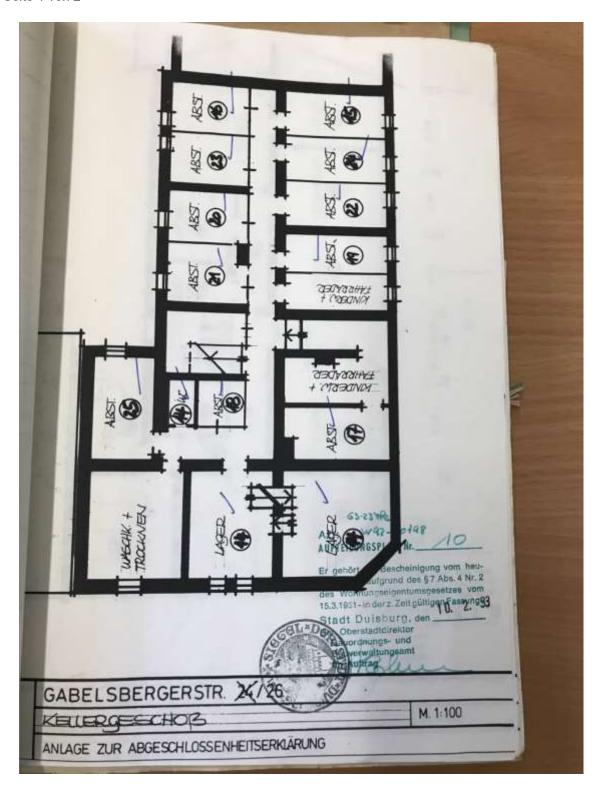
Quelle: Teilungserklärung; Grundriss des Kellergeschosses
